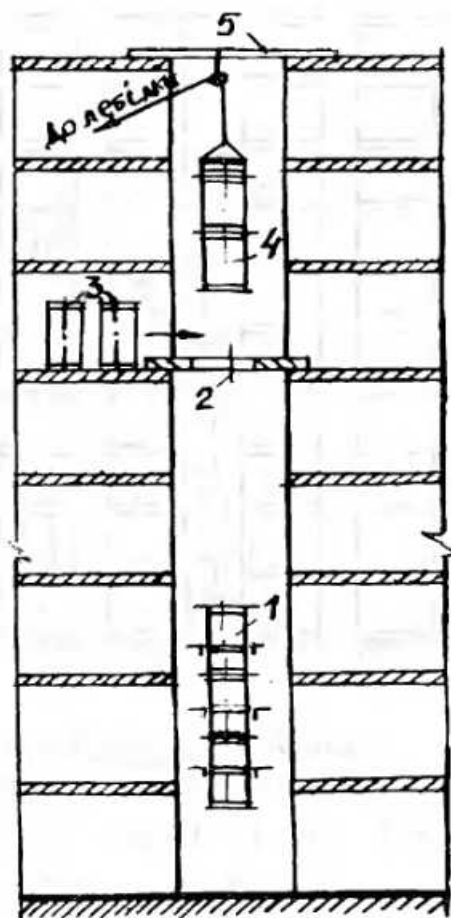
Монтаж вертикальних повітропроводів способом нарощування зверху: 1 - повітропровід на кронштейнах; 2 - настил; 3 - елементи повітропроводу; 4 - ланка повітропроводу; 5 - вантажна балка
